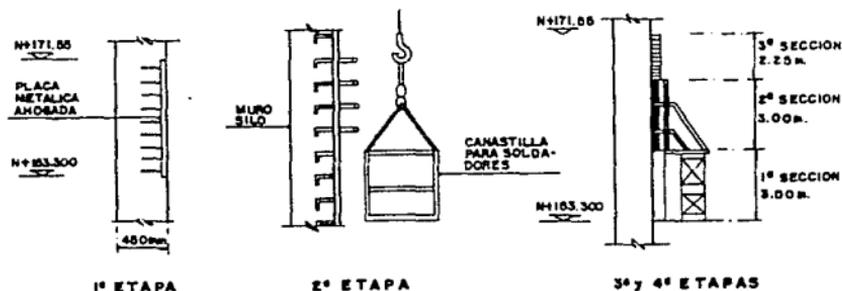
Vista en elevación construcción columnas N+171.55
